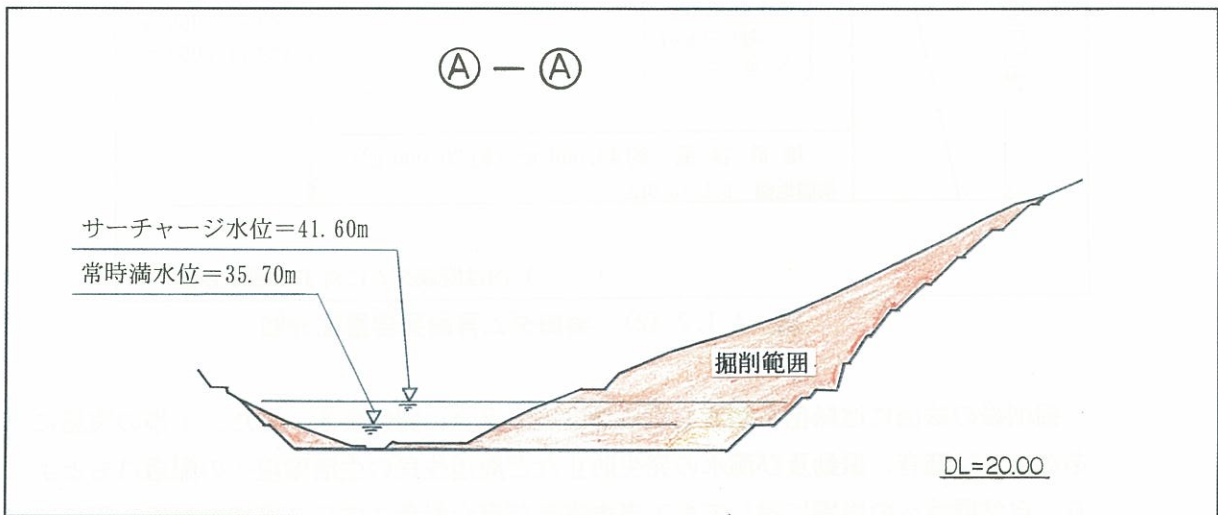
(4) 標準断面図 (S=1:2,000)
